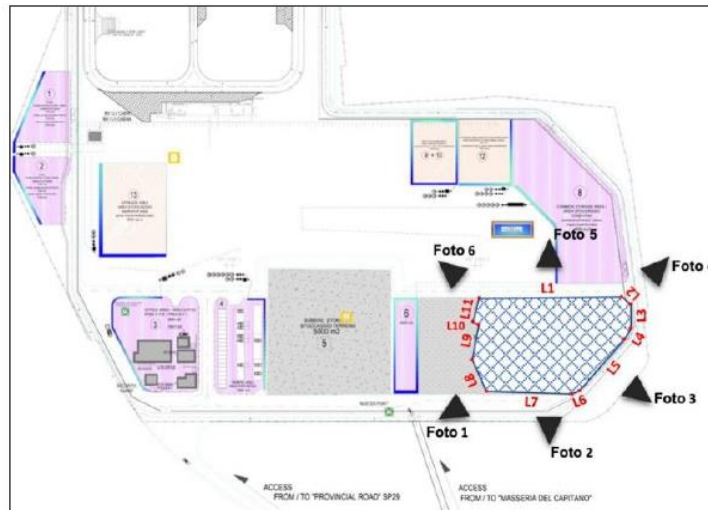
Posizione cumuli Top Soil nel layout di cantiere -fase 2
